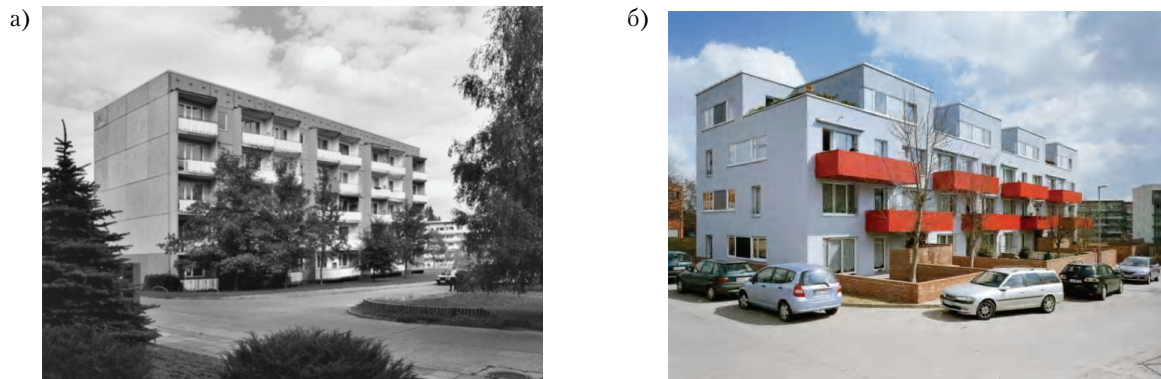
Панельный дом в г. Лайнефельде, Германия (а – до реконструкции, б – вид дома после реконструкции).
